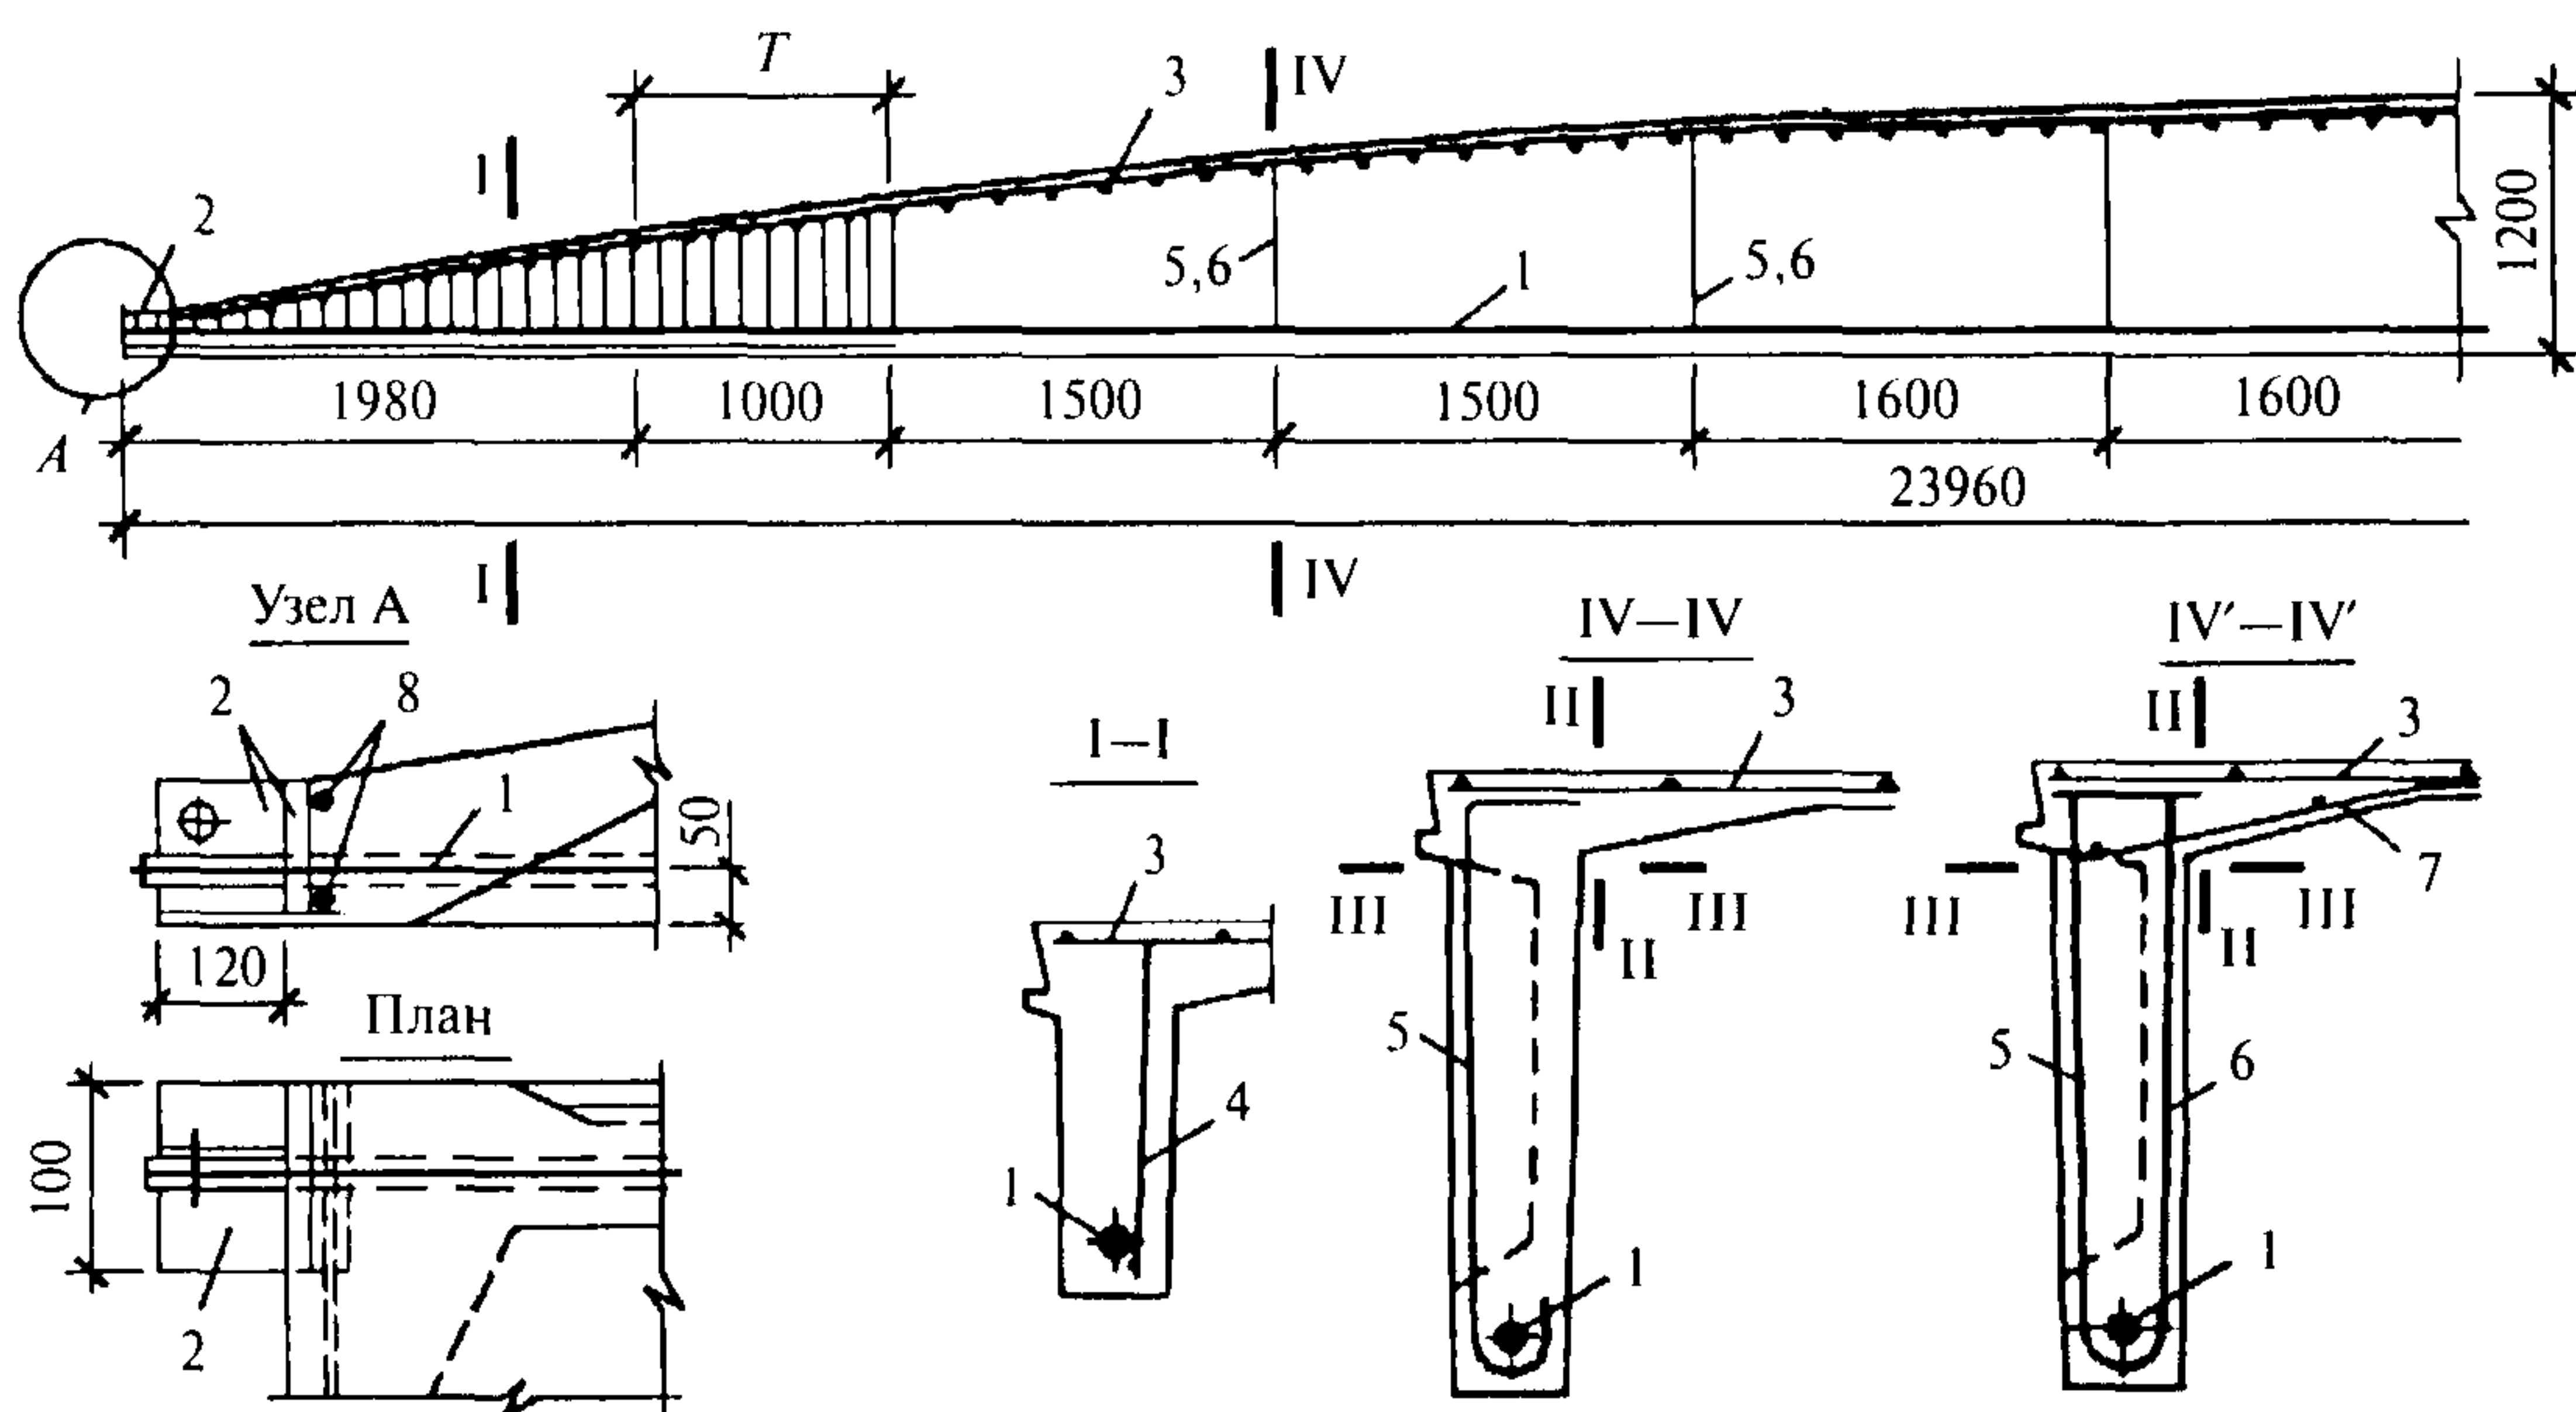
Армирование панели-оболочки КЖС размером 3×18 м:
